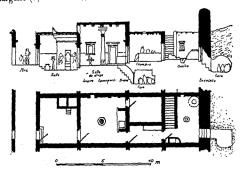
Plan type d'une maison à Deir el Medineh.
